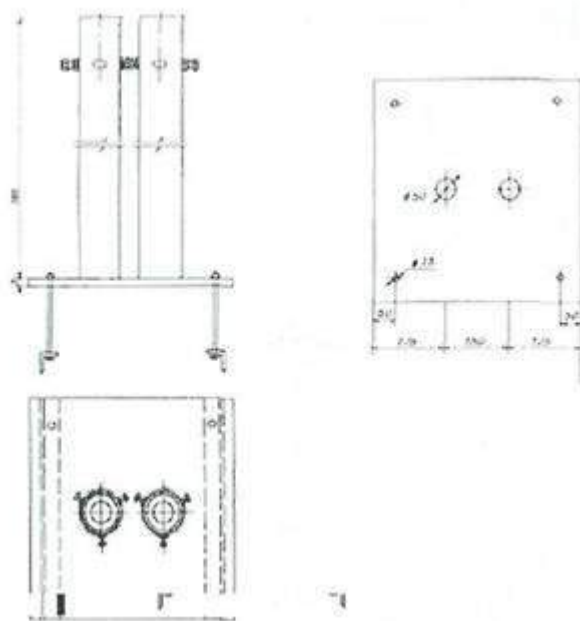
Опорная плита с двумя приваренными гильзами для установки стойки вместе с выводной трубой.
